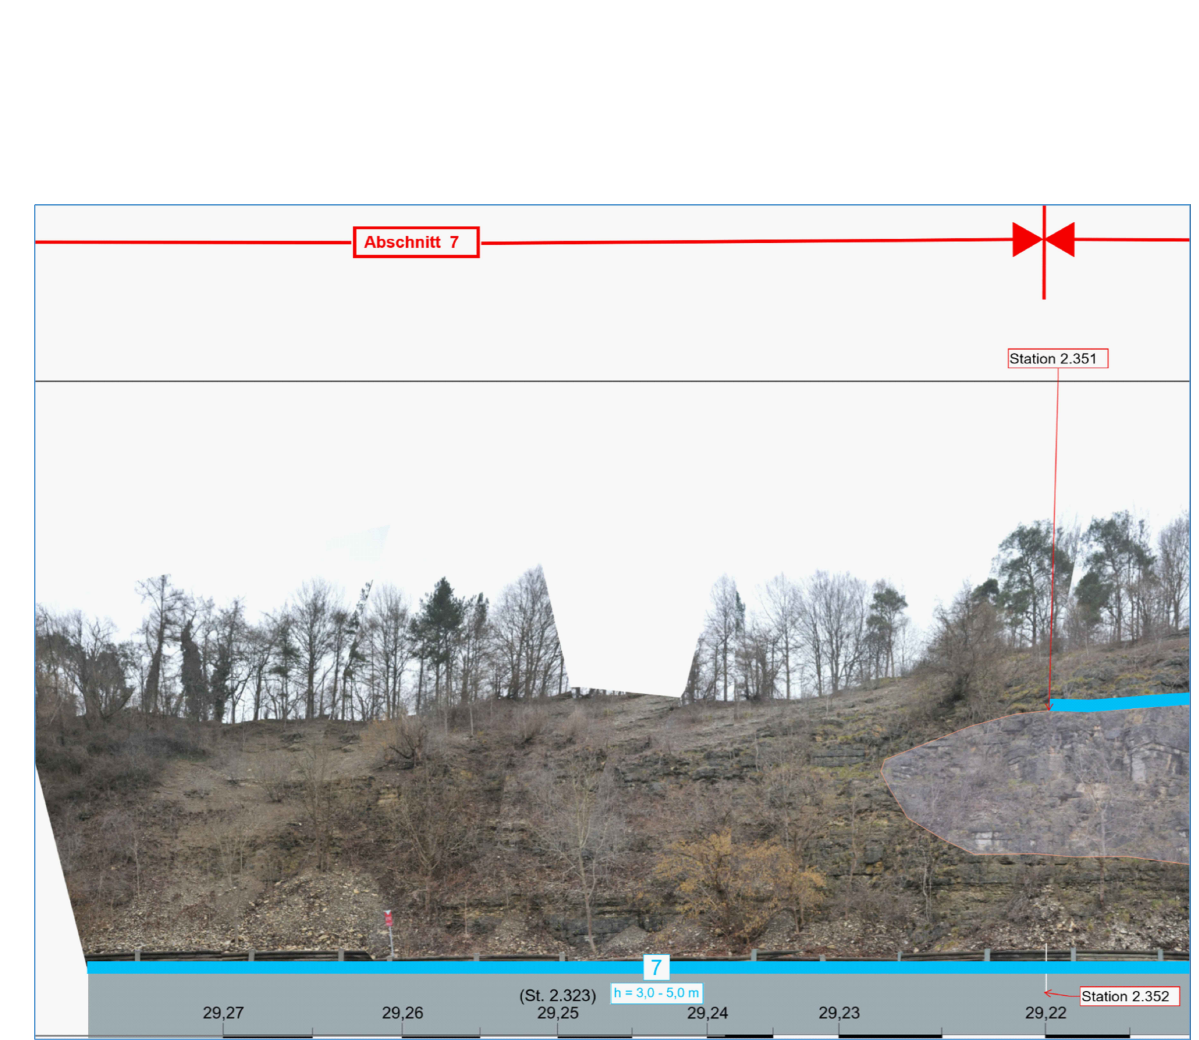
Abschnitt 7, gemäß Planung aus Plan 5.2.7 östlich
